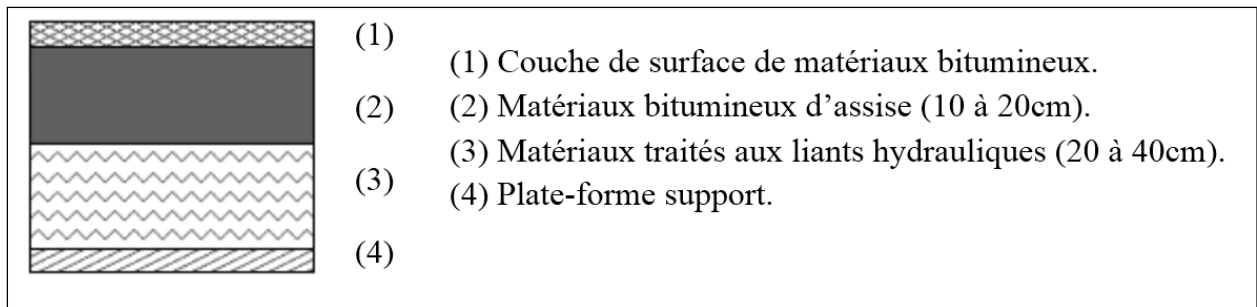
Structure d'une chaussée à structure mixte (MEZIANI, 2008)
